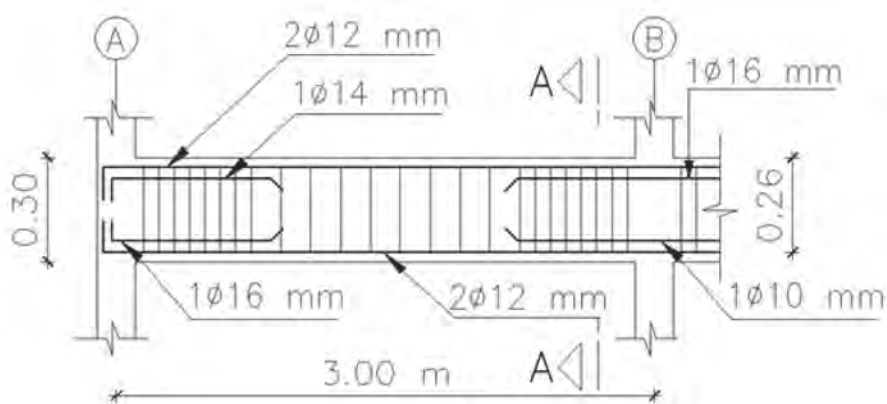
Armadura longitudinal y transversal en vigas eje 1
